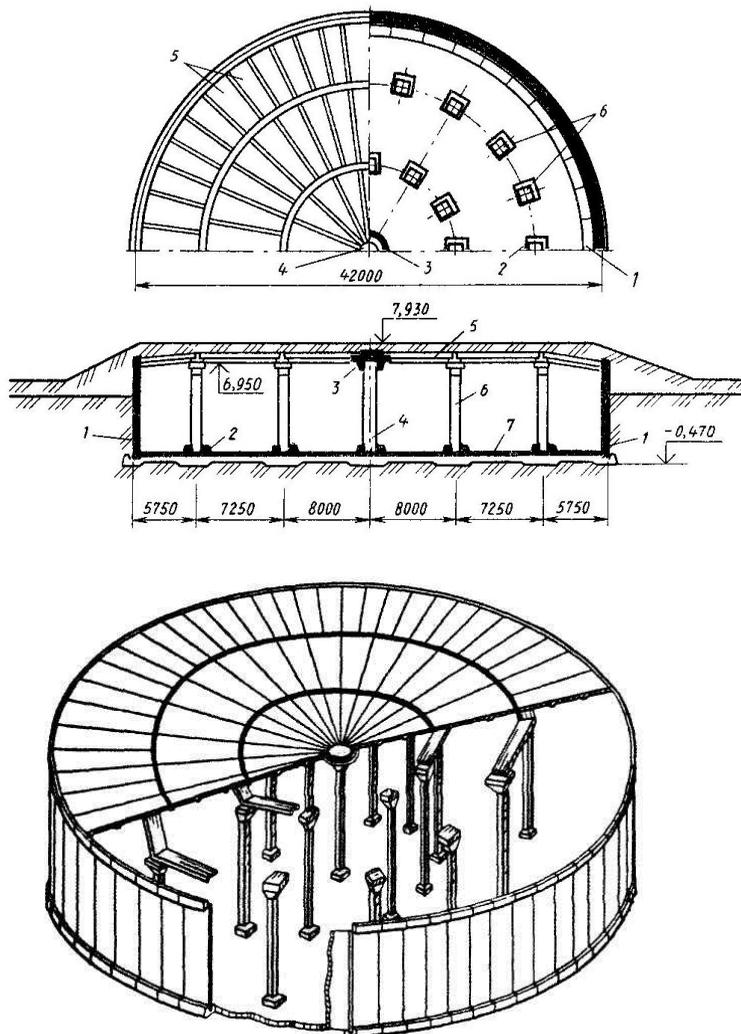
Сборный железобетонный цилиндрический резервуар: 1 – стенная панель, 2 – опорный стакан, 3 – центральная плита, 4, 6 – колонны, 5 – плиты покрытия, 7 – днище из монолитного железобетона
